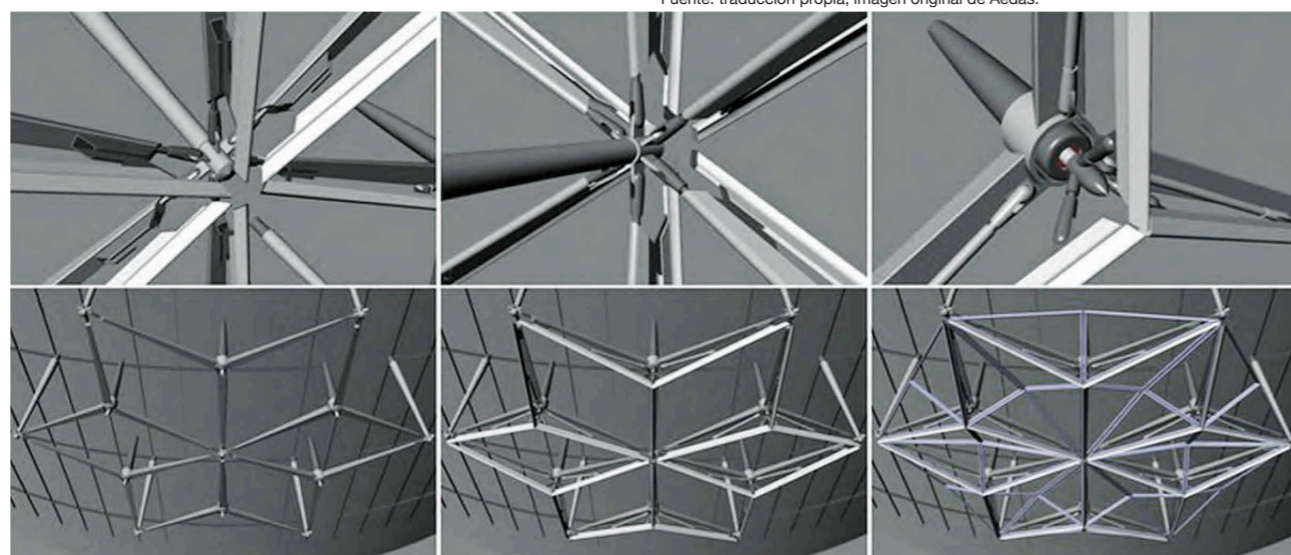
| Construcción mashrabiya fachada Abu Dhabi Investment Council. Fuente: Aedas
